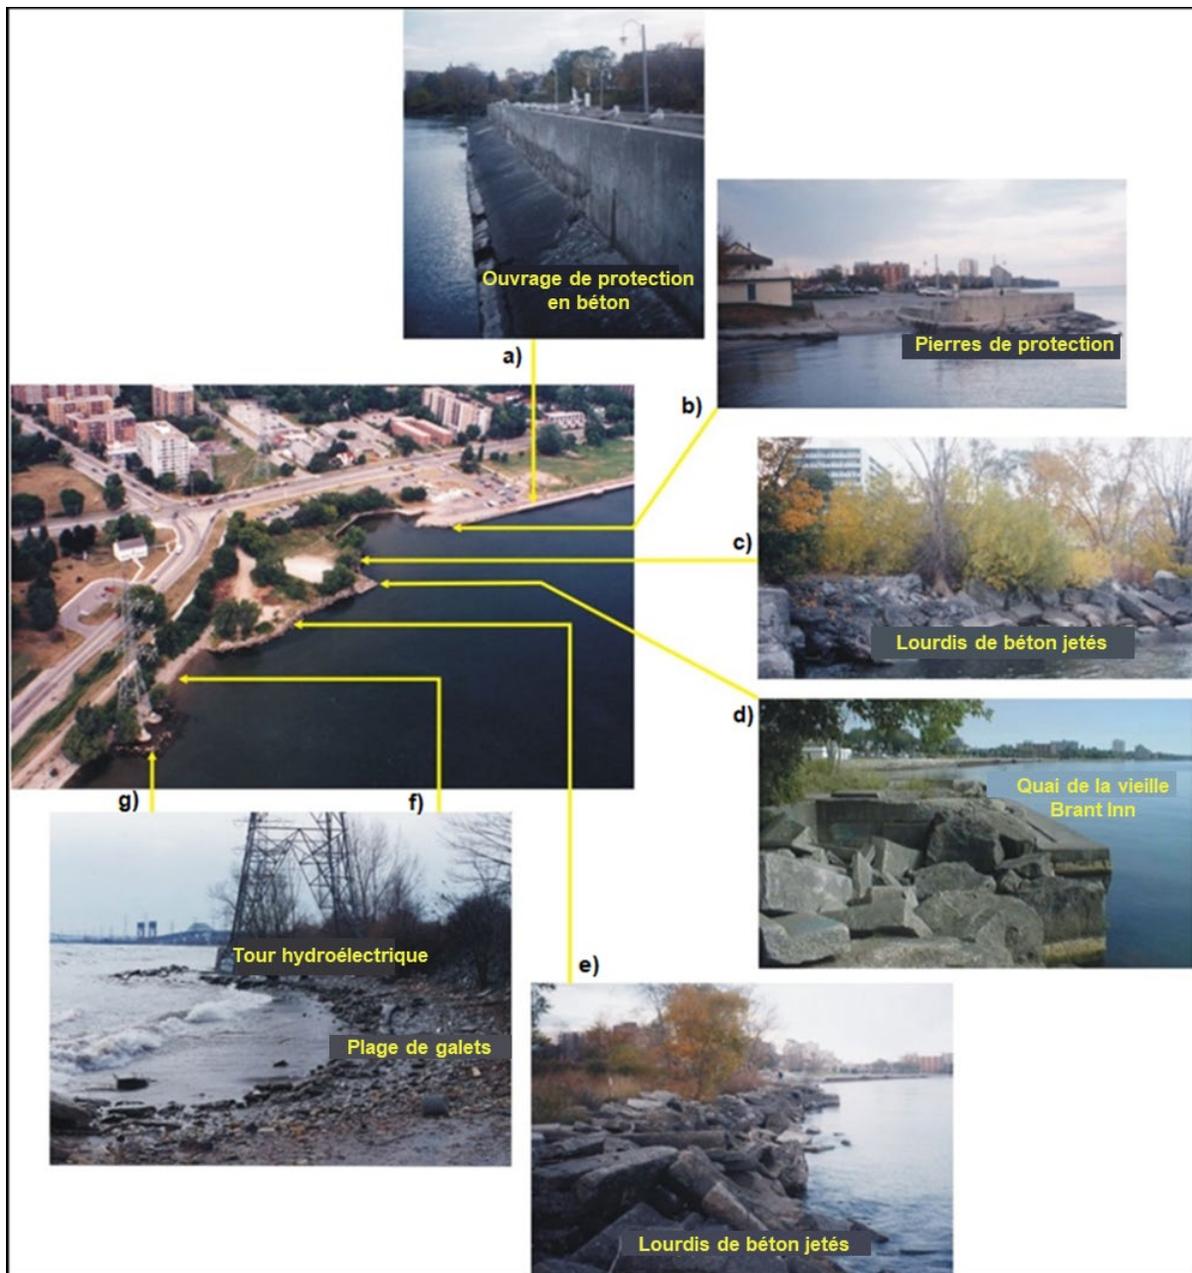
Nœud de Brant Inn, Burlington (Ontario), Conditions avant la construction, photographies du site montrant a) un ouvrage de protection en béton, b) un ouvrage de protection en béton avec des pierres de protection, c) des lourdis de béton jetés, d) la vieille jetée en béton de la Brant Inn, e) davantage de lourdis de béton jetés, f) une petite plage de galets et g) une tour hydroélectrique le long du littoral actif.
